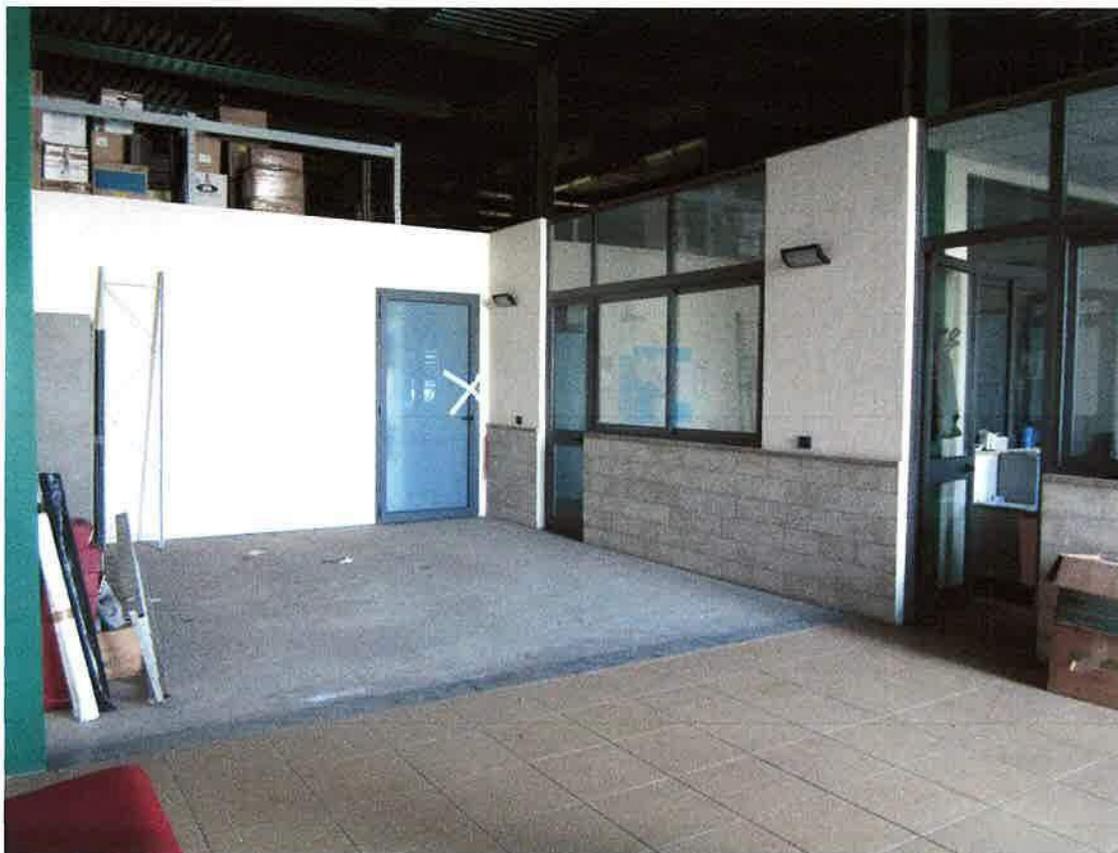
a destra il box che ospita una seconda postazione di controllo al piano terra e, al centro, la porta da cui si accede al magazzino
